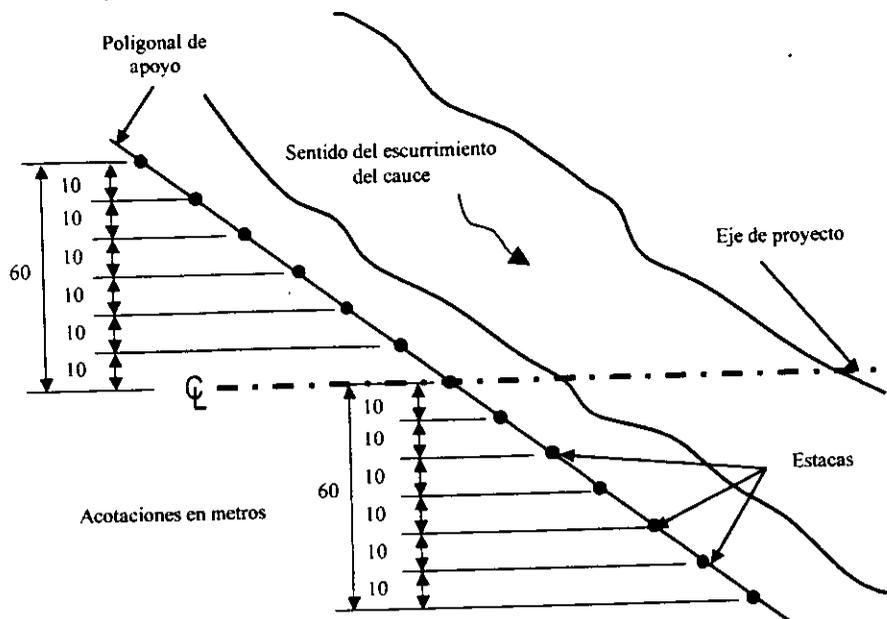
Ubicación de las estacas sobre la poligonal de apoyo para sustentar las secciones topográficas para el plano de Planta Detallada
